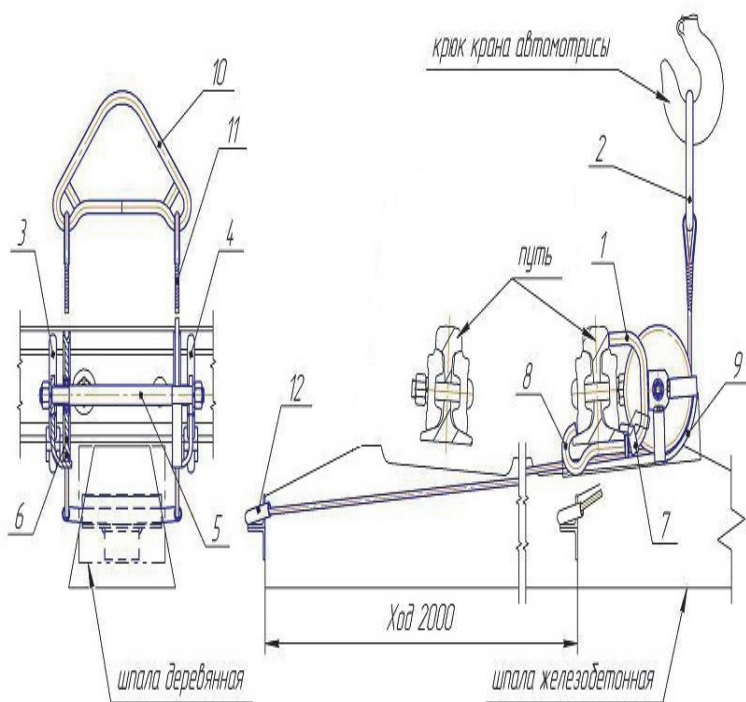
Общий вид устройства для одиночной смены шпал автомотрисой
